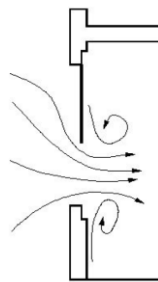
Flussi di aria attraverso finestra, con apertura a scorrimento verticale, a doppia anta (vista in sezione)
